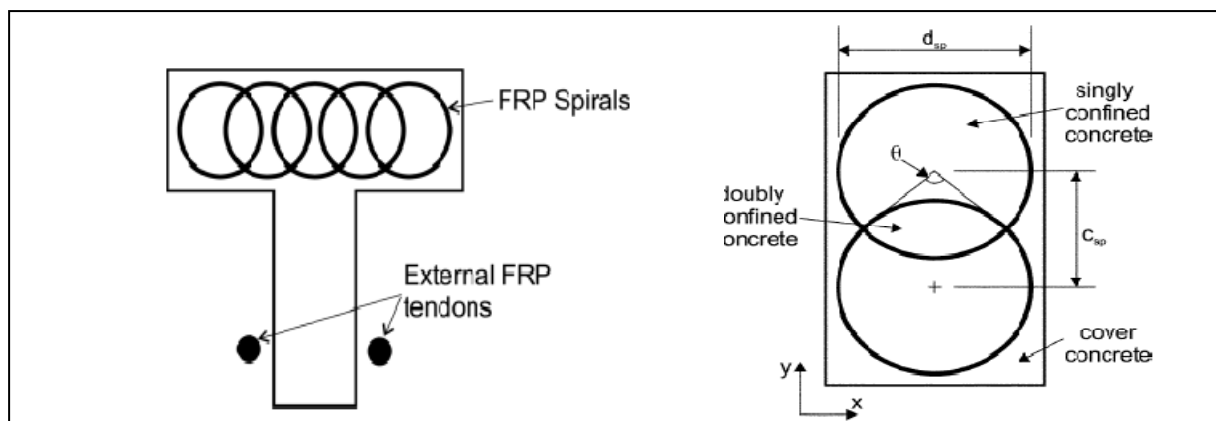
Conception de la poutre proposée (section en béton avec deux spirales imbriquées). [25]
